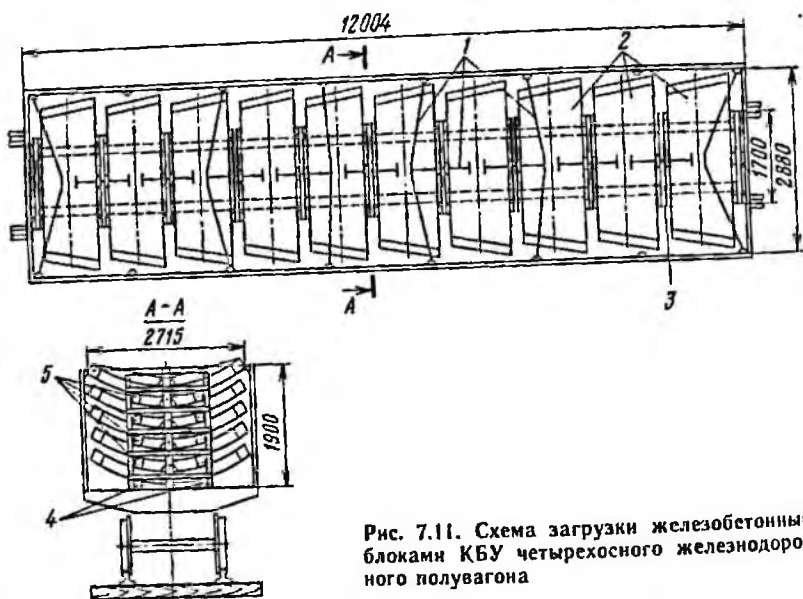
Схема загрузки железобетонными блоками КБУ четырехосного железнодорожного полувагона
